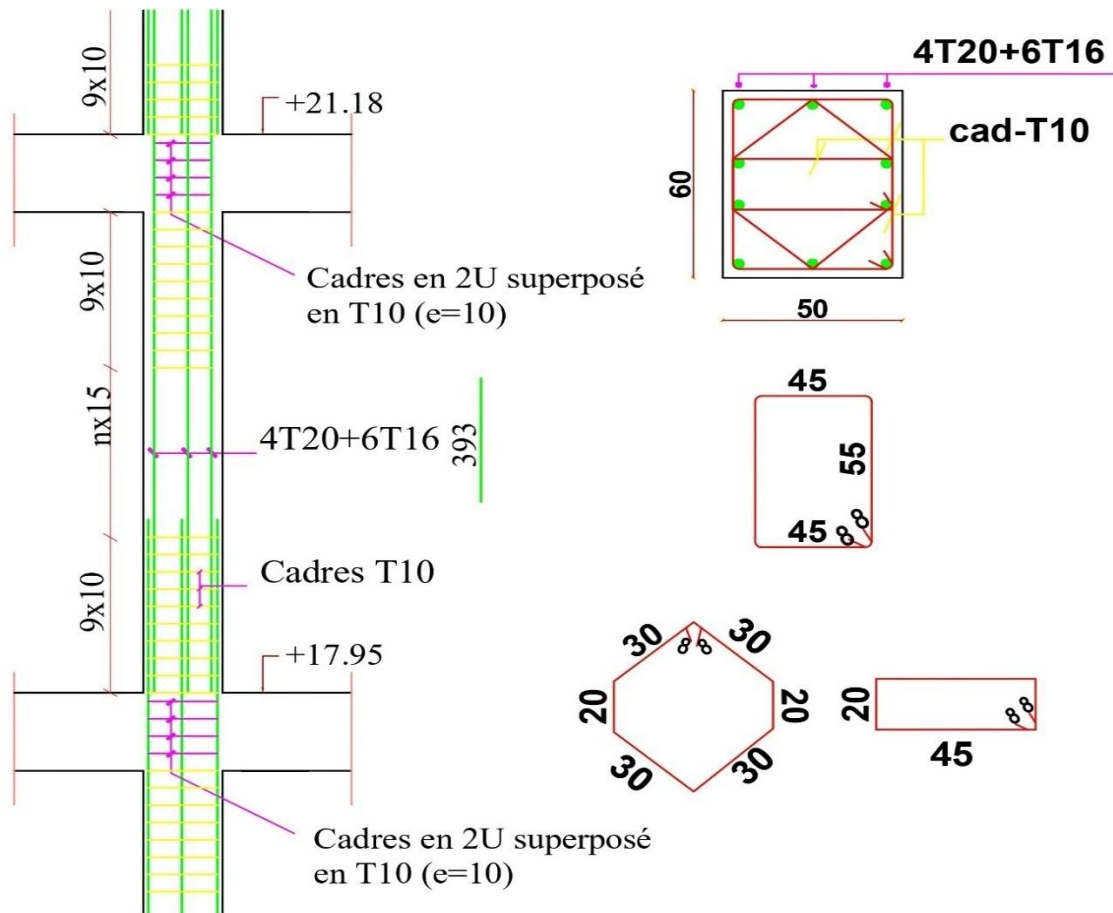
Schéma de ferrailage du poteau (60×50)
